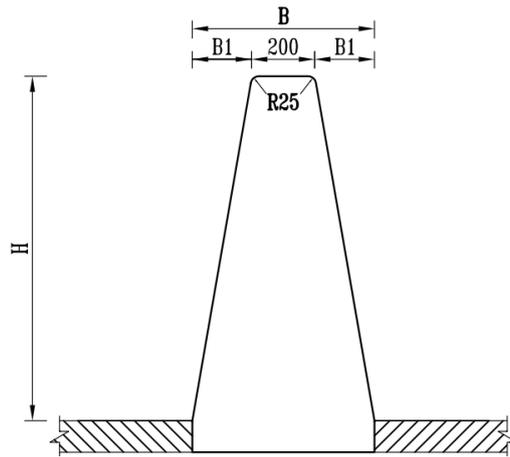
单坡型中央分隔带玻璃纤维钢筋混凝土护栏（尺寸单位：cm）
